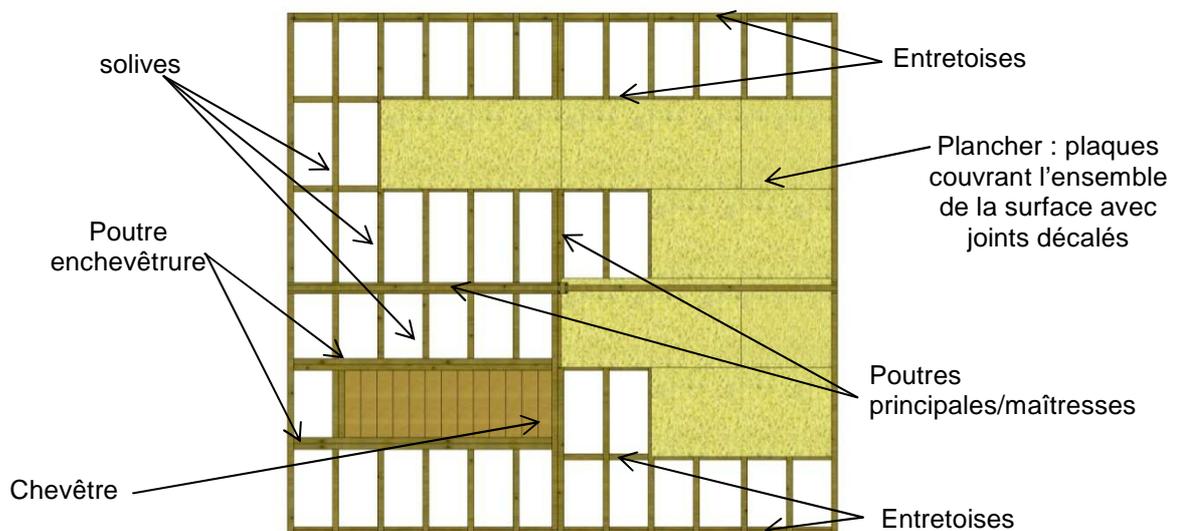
Schéma de principe constructif d'un plancher bois (Plan ; tous les panneaux ne sont pas représentés)
